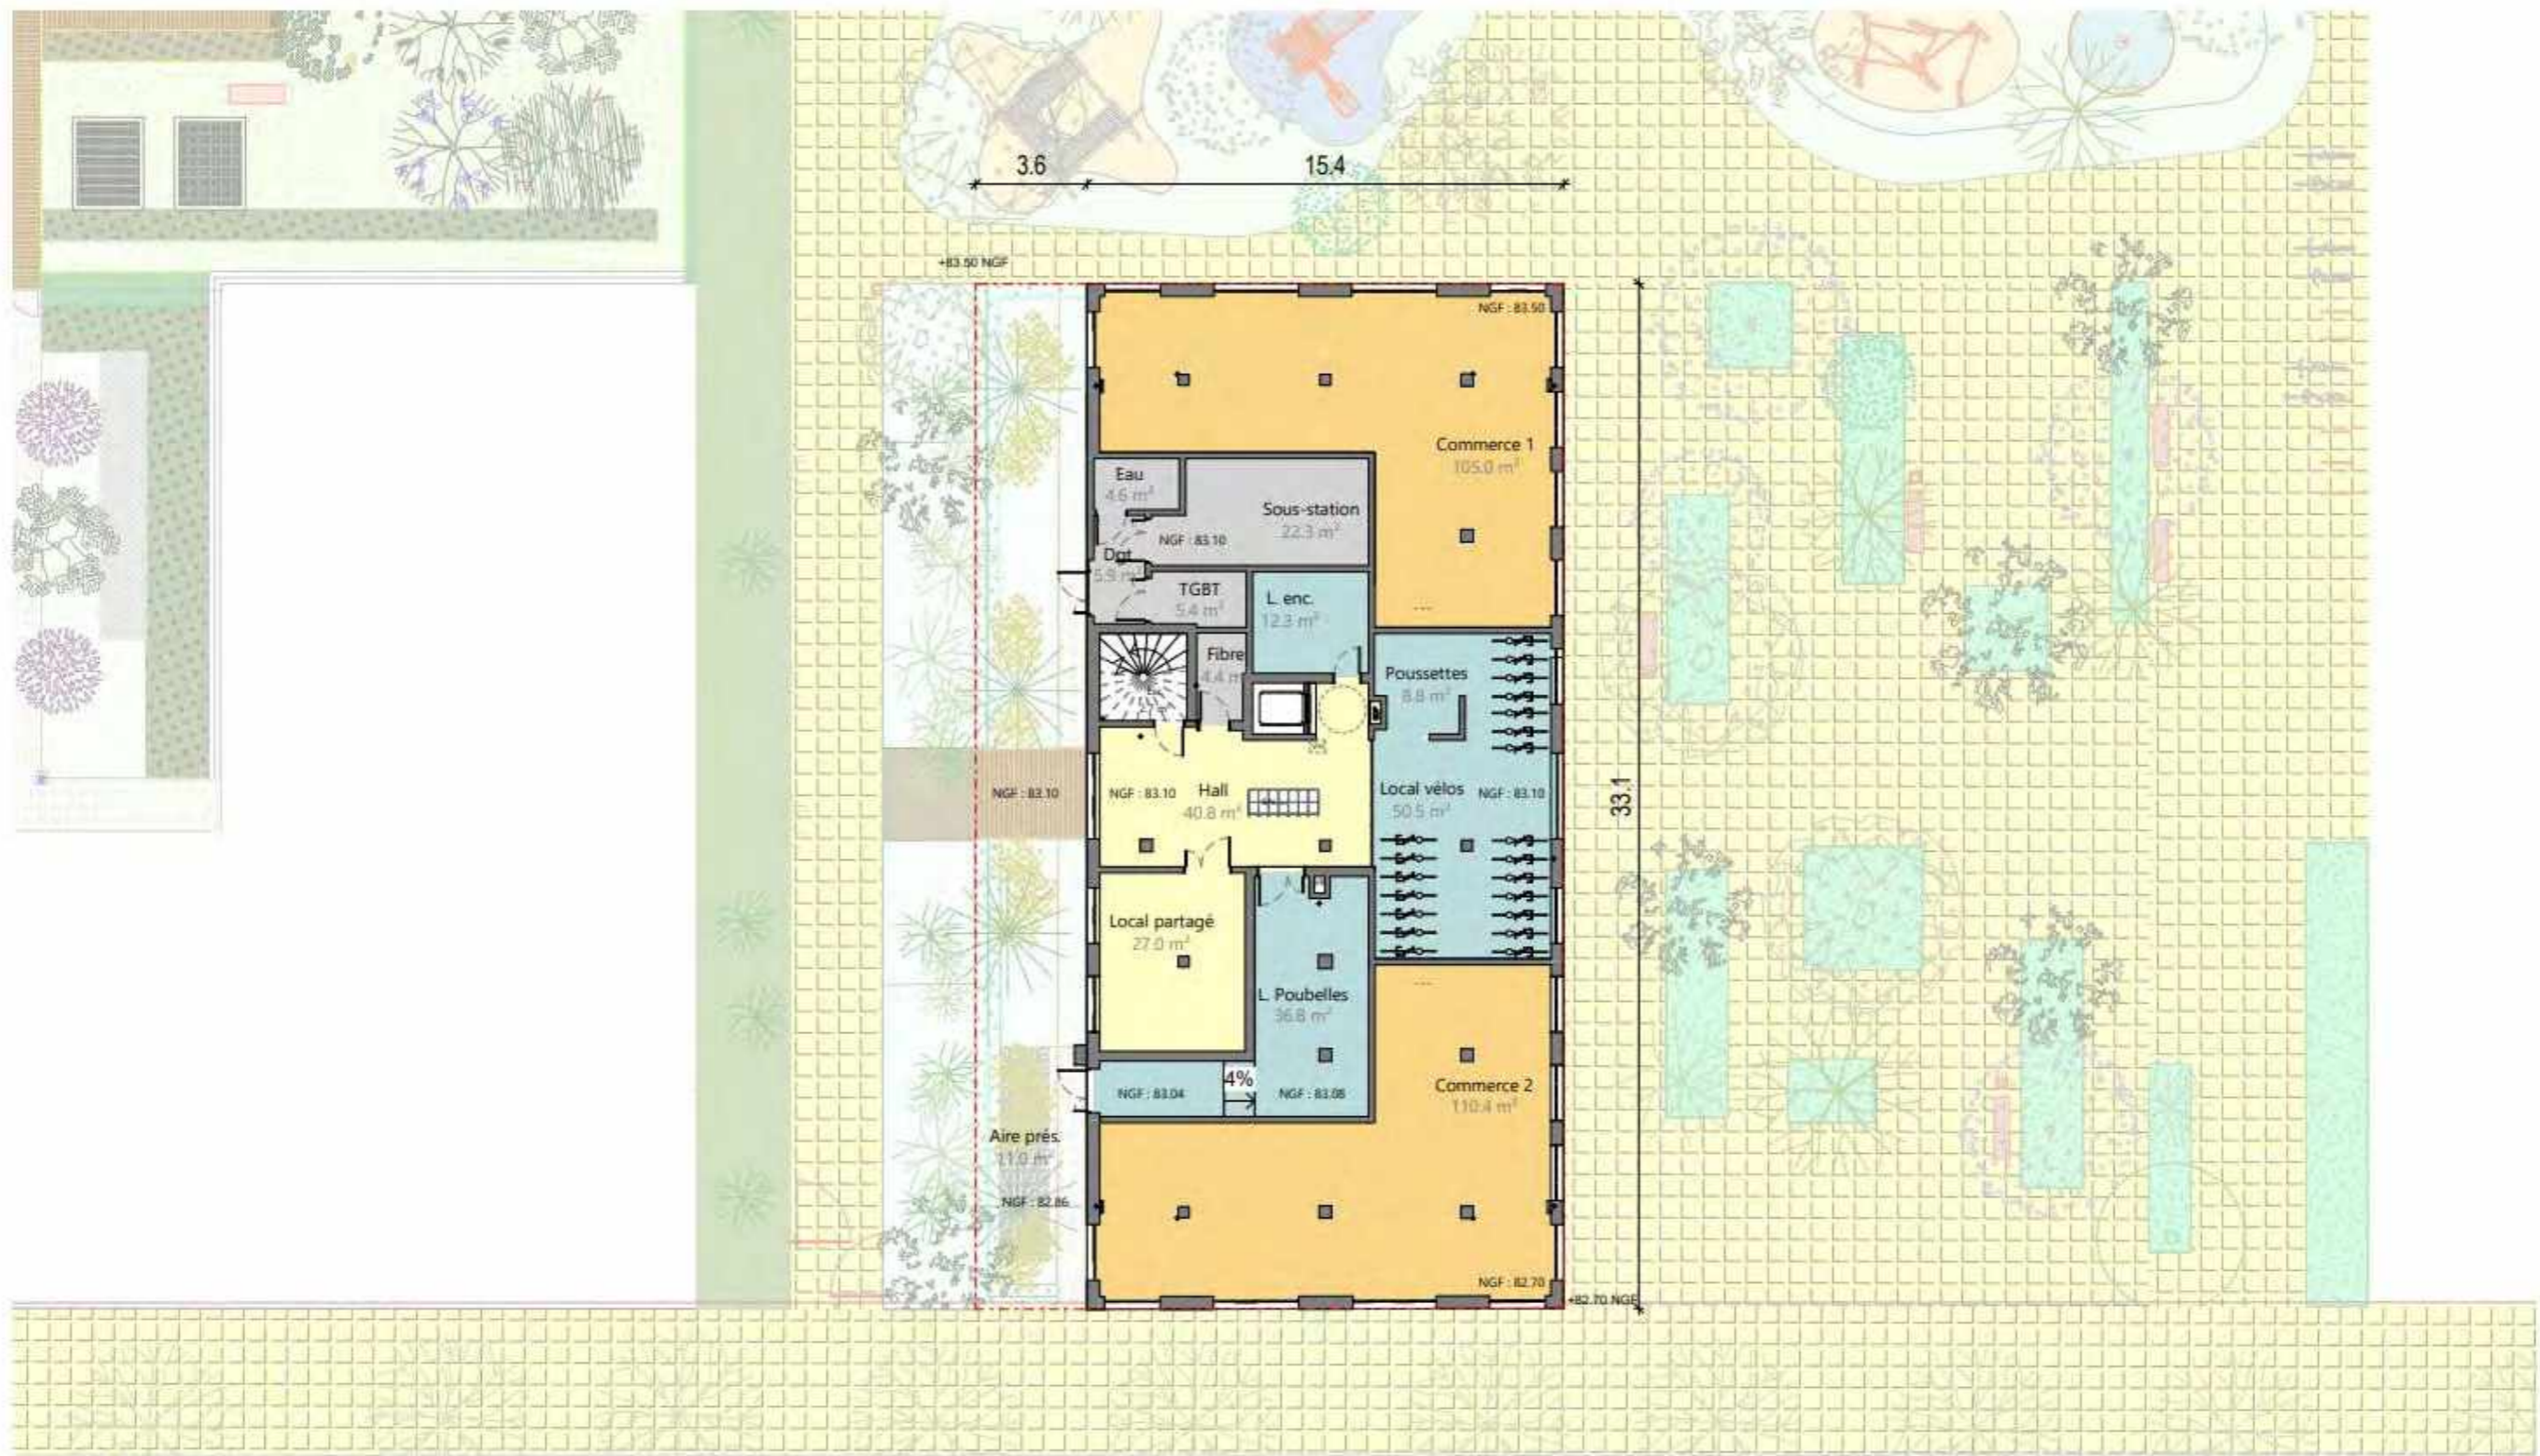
Plan masse du RDC des bâtiments du lot 4.4
